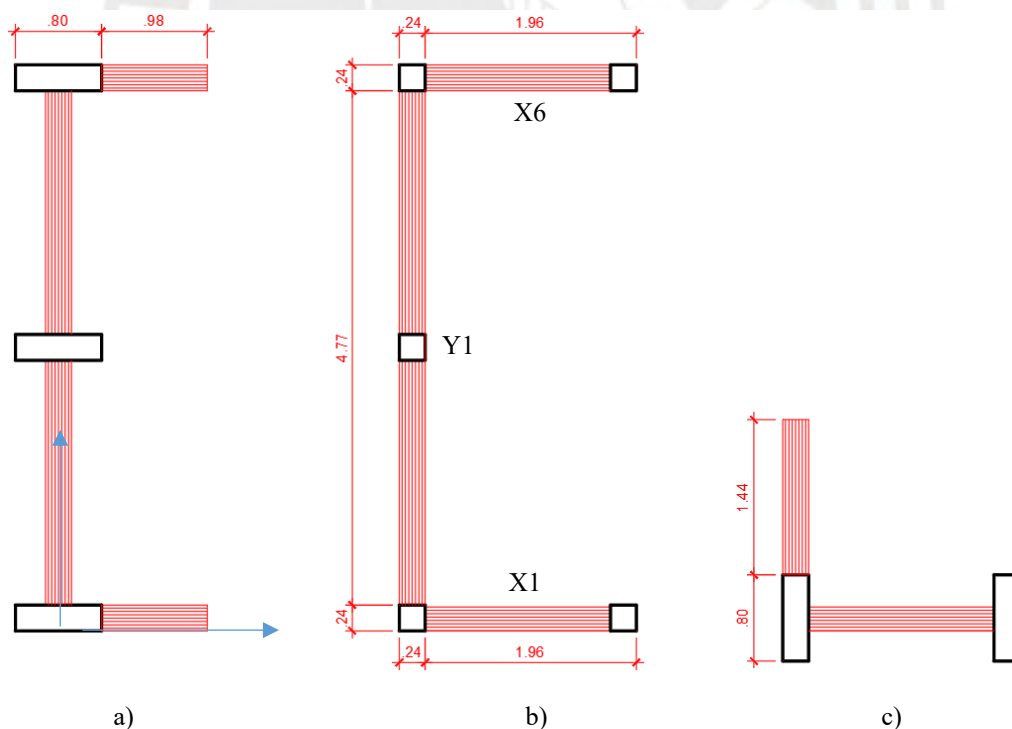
a) Sección transformada del muro "Y1", b) Muro real, c) Sección transformada del muro "X1".
